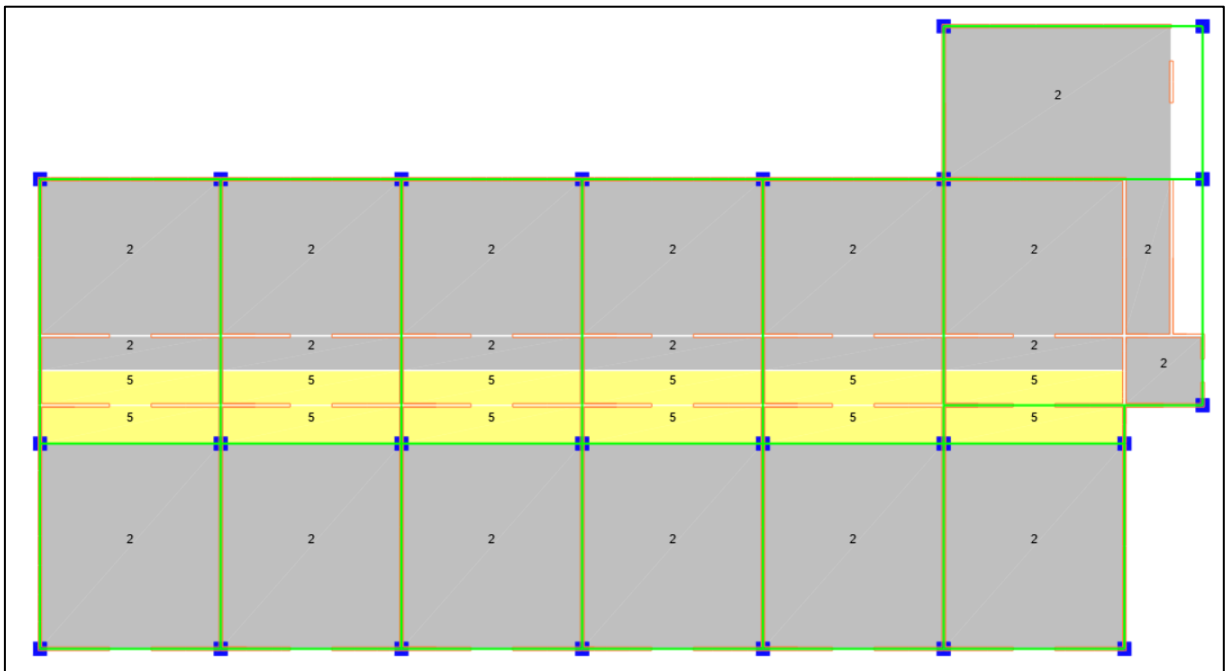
Cargas vivas sobre-impuestas en losa entrepiso [kN/m<sup>2</sup>]
